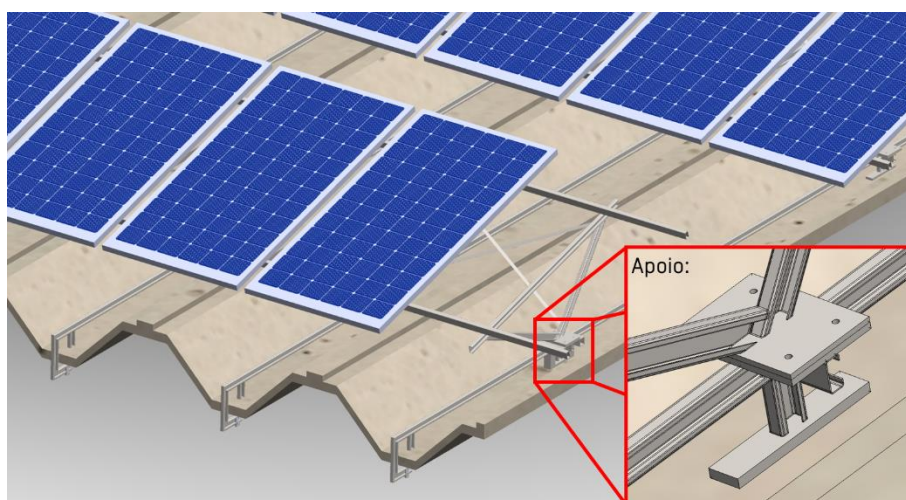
Estrutura de suporte de painéis fotovoltaicos (detalhe do apoio) – modelo CAD 3D.
